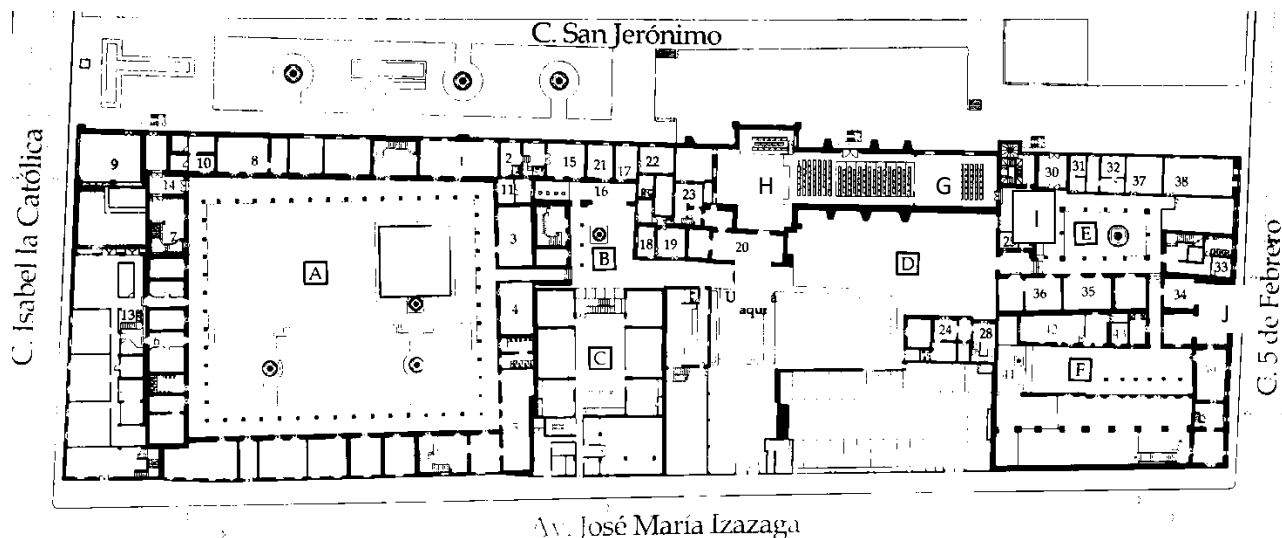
Planta baja de la Universidad del Claustro de Sor Juana, antiguo Convento de San Jerónimo.
